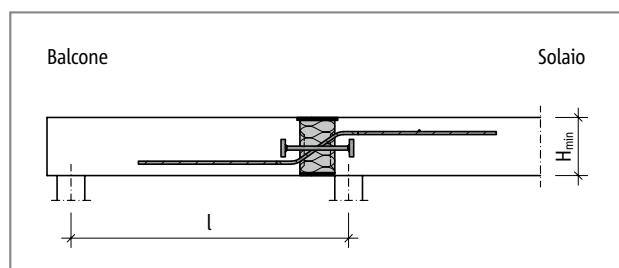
Schöck Isokorb® XT tipo QP: schema statico
